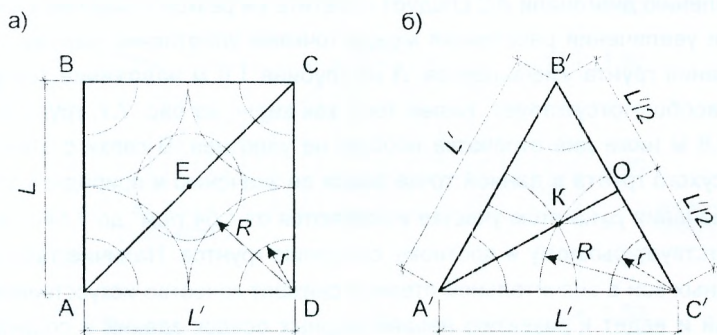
Схема уплотнения грунтов: а – квадратная; б – треугольная
